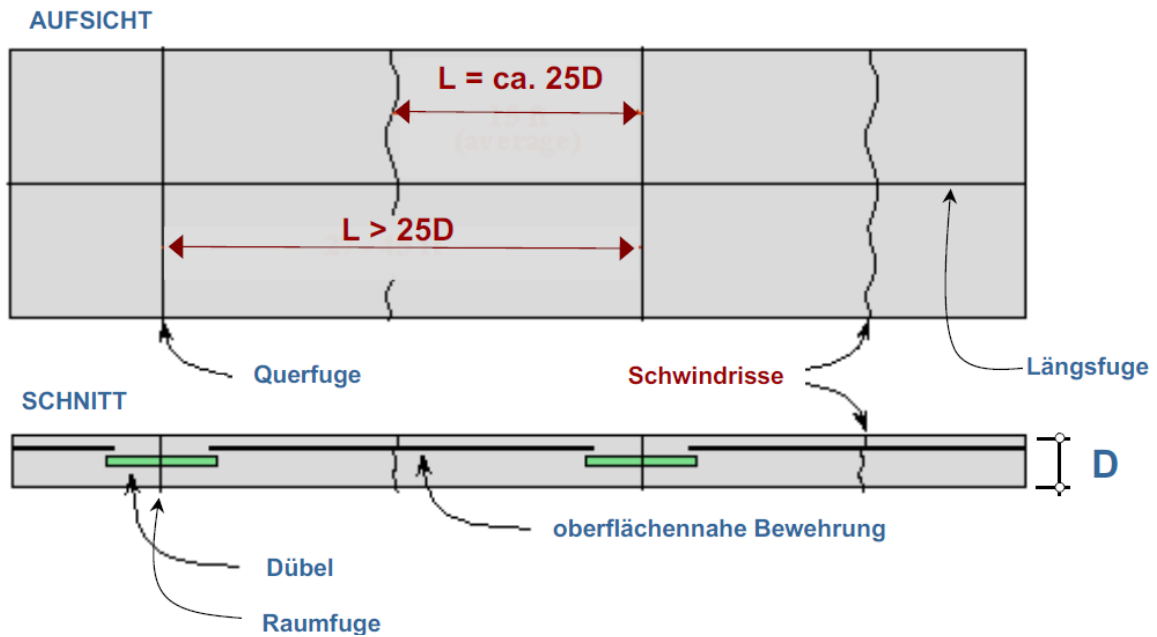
Betondecke bewehrt mit Raumfuge [5]
